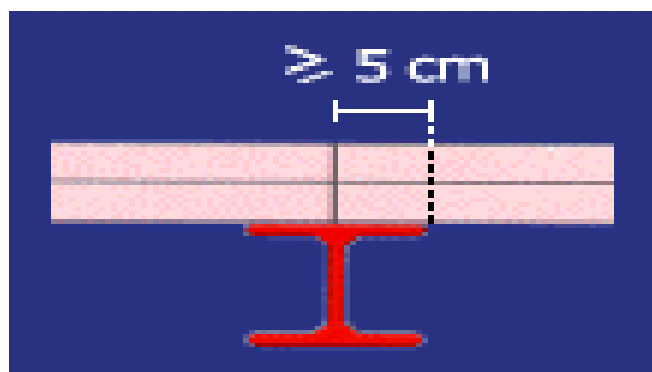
Apoio mínimo do painel de laje sobre estrutura metálica
